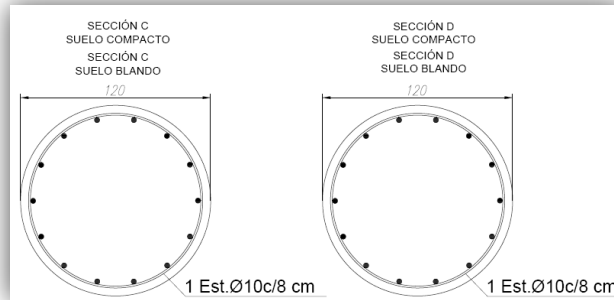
Detalle armadura estribo zunchado pilote, sección C y D
